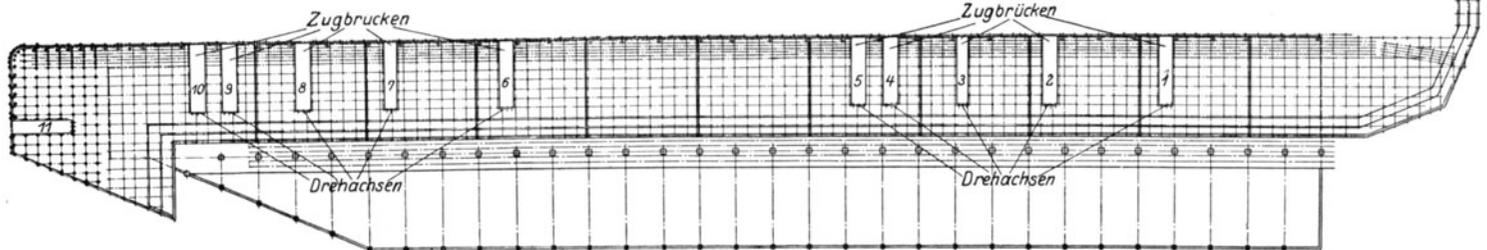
Pacific Pier. Fundierung und Konstruktionseinteilung nebst Lage der drehbaren Zugbrücken.
